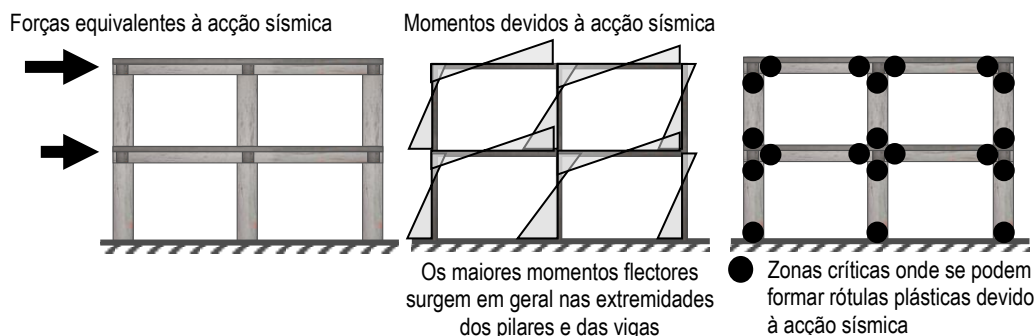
Zonas críticas em estruturas de betão armado [Lúcio, 2007]
